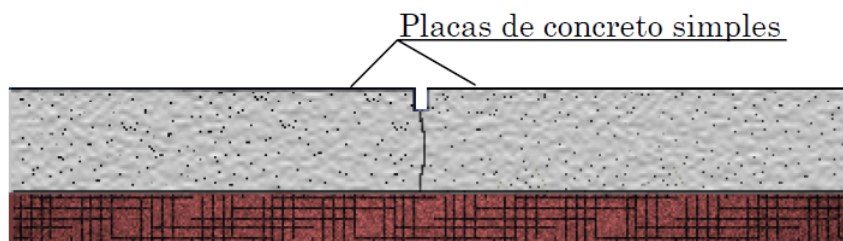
Constituição do pavimento rígido (Oliveira, 2000)
